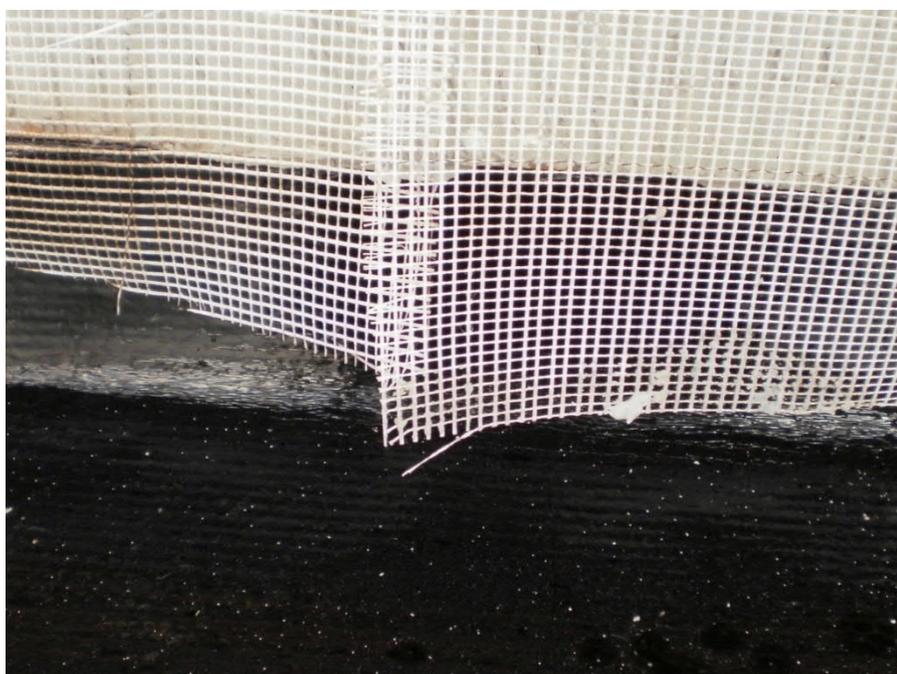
Scarsa sovrapposizione della rete (da: Archivio Caparol 2015)
